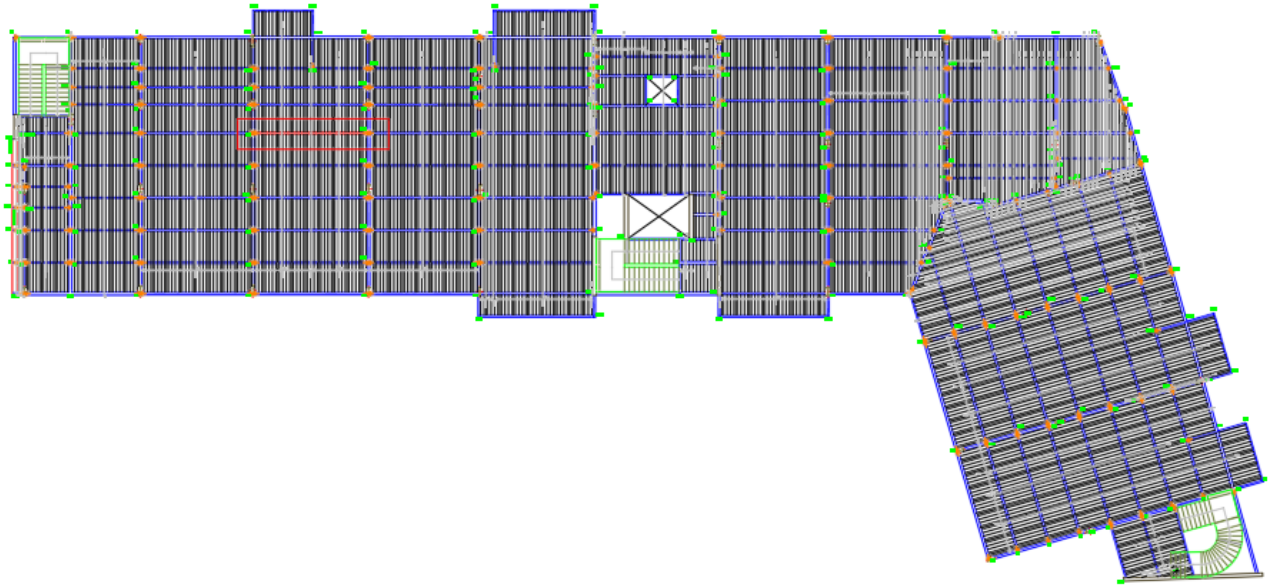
Viga IPE del forjado de planta marcada en rojo con un recuadro rojo seleccionada para el cálculo de viga tipo
